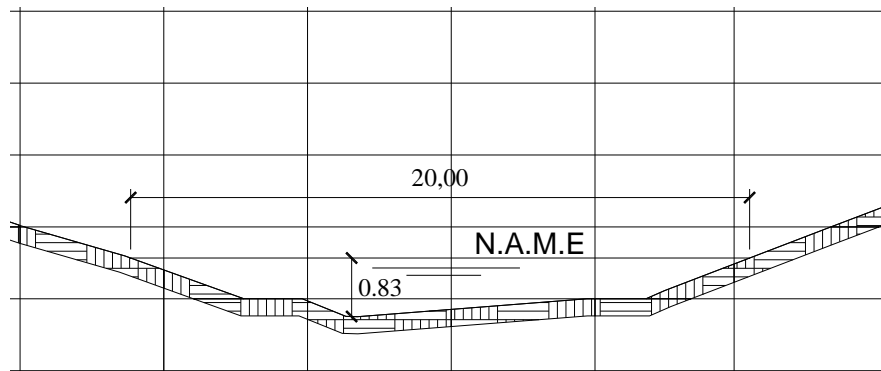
Sección transversal de la quebrada Verdum.
